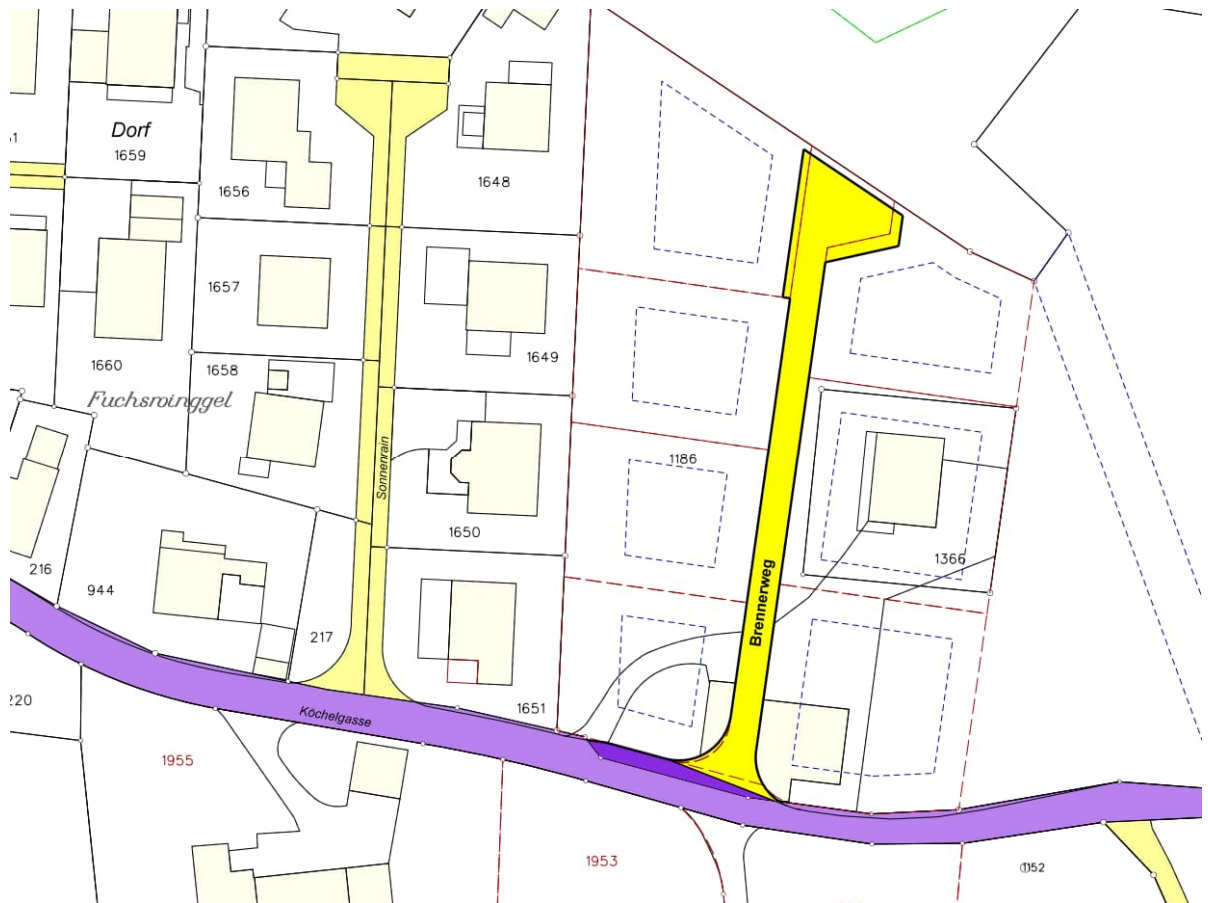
Ausschnitt Situation Teilstrassenplan, Plan Nr. 1331 03.91-2
